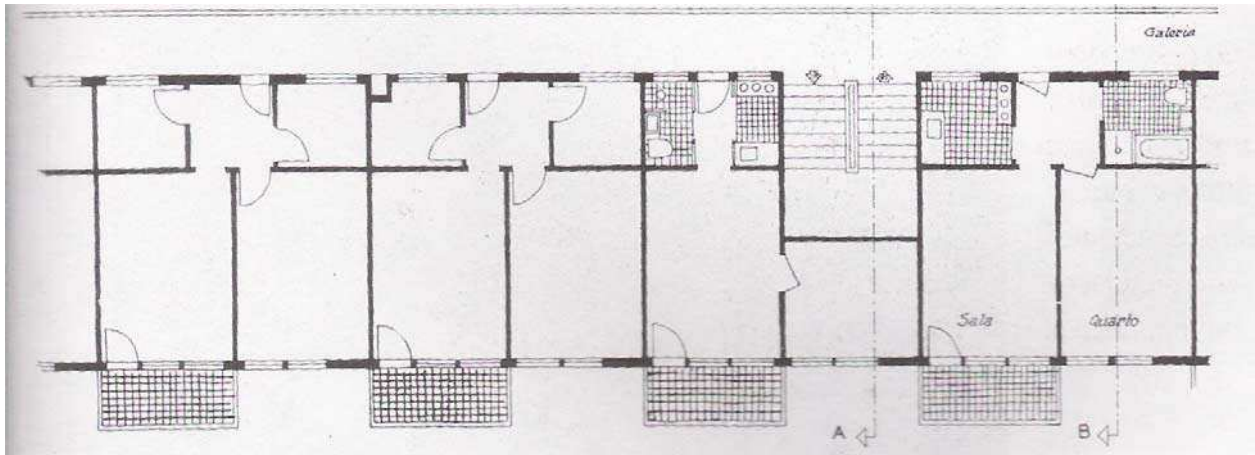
Planta tipo dos apartamentos, aonde nota-se um espaço mínimo para a Cozinha
